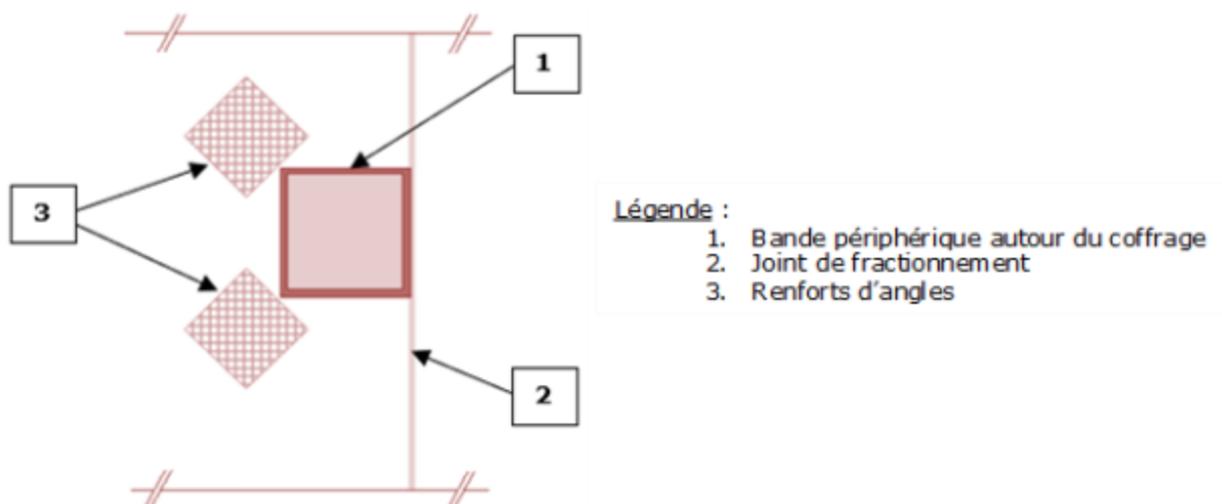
Positionnement des renforts d'angle au droit d'un coffrage
